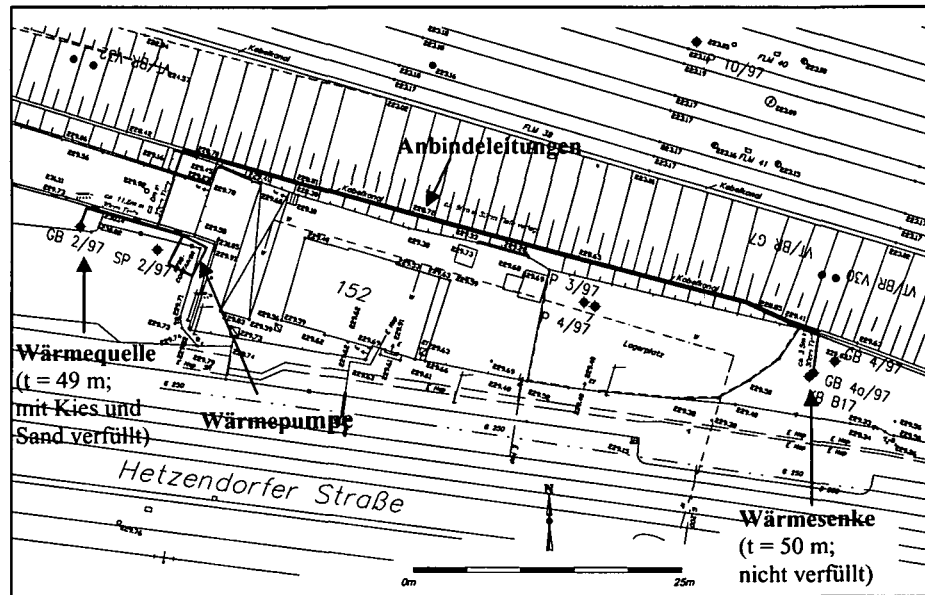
Lageplan der Versuchsanlage in der Hetzendorferstraße im 12. Wiener Gemeindebezirk.
